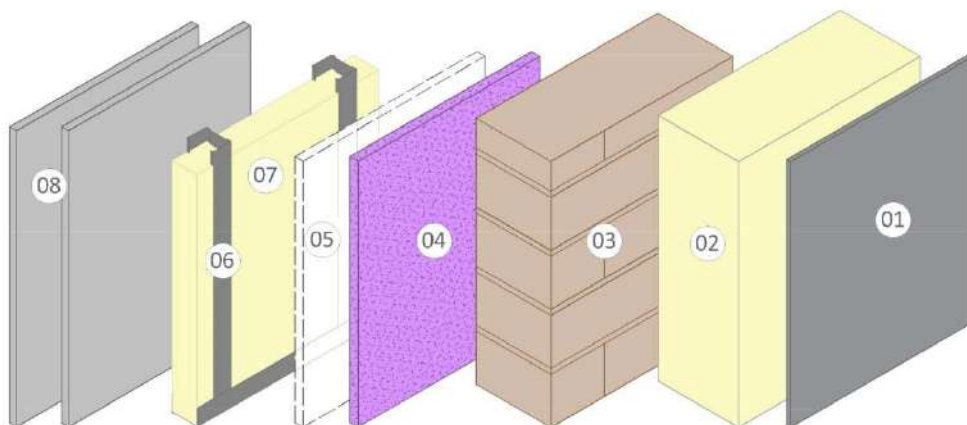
Sección vertical de un ejemplo de uso de Placo® Hermetic en fachada ventilada.
